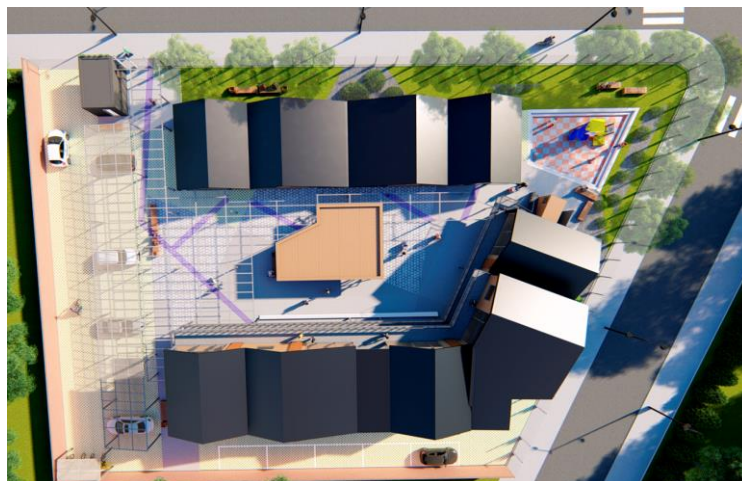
;61;62 – Implantação; Fachada; Interno. Fonte: Karkle, 2018.
